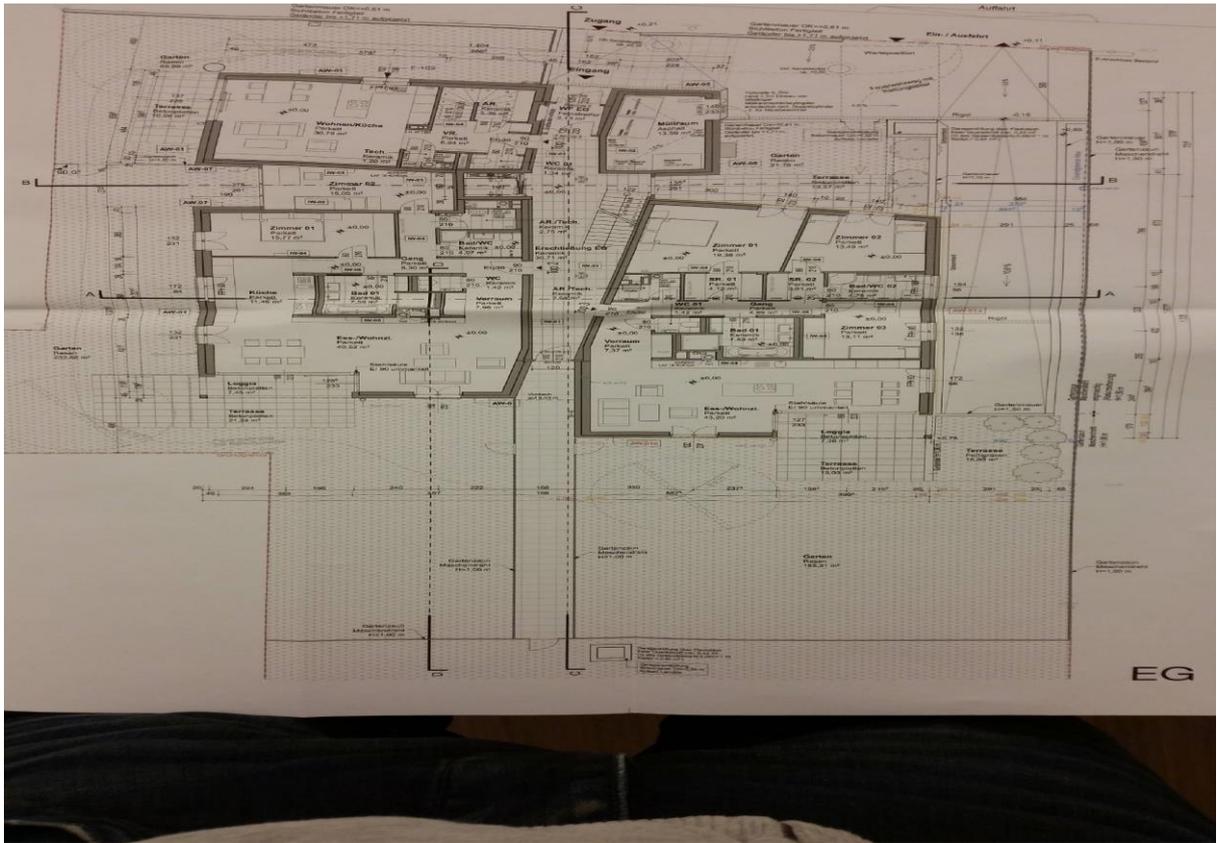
Auszug aus Grundriss von Erdgeschosswohnungen
